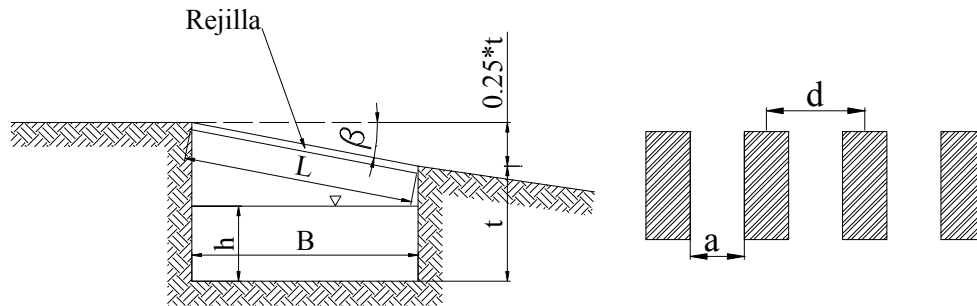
a) esquema dimensiones de la cámara de captación; b) sección rejilla.
